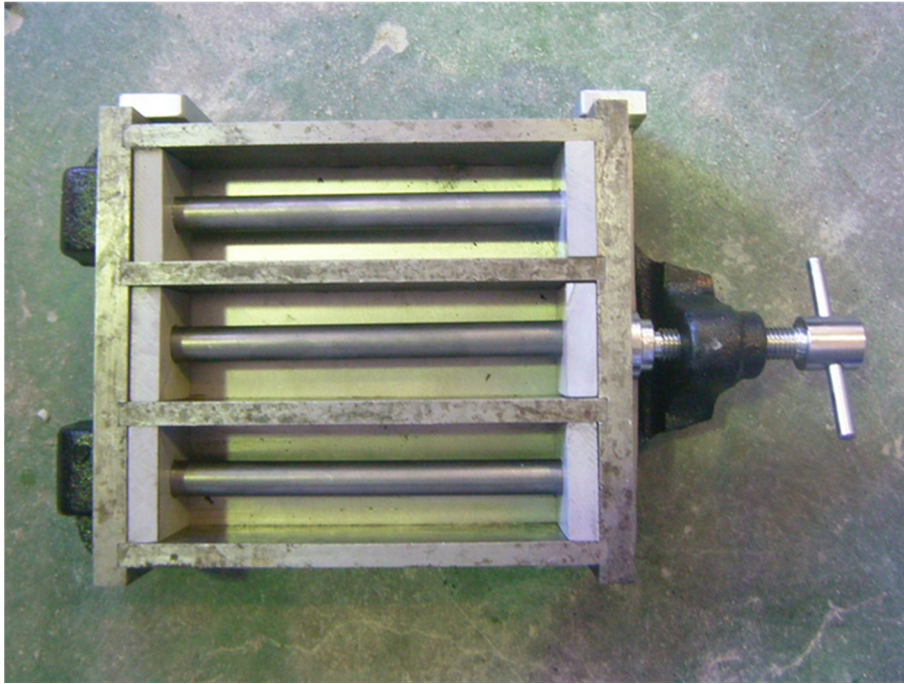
ひび割れのないモルタル供試体の型枠
